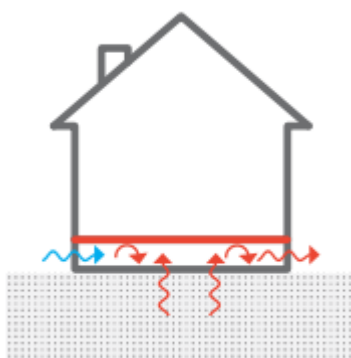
Barrera anti-radón y cámara de aire ventilada instalados. Fuente:[27].
